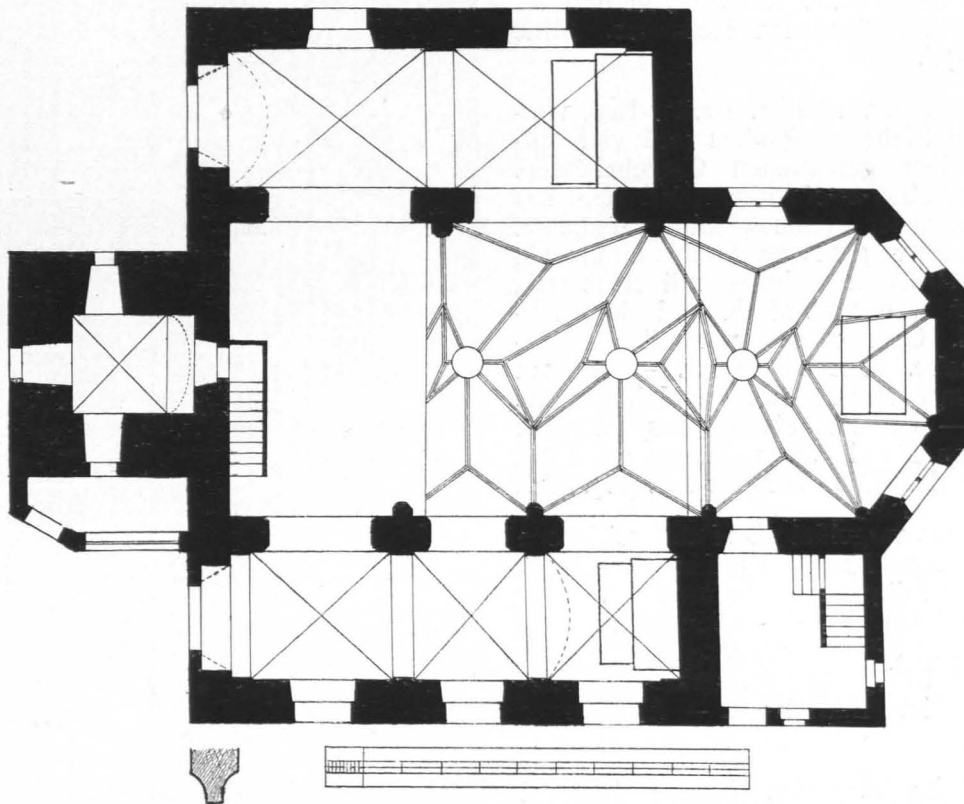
Nußdorf, Pfarrkirche, Grundriß 1:200 (S. 559)
